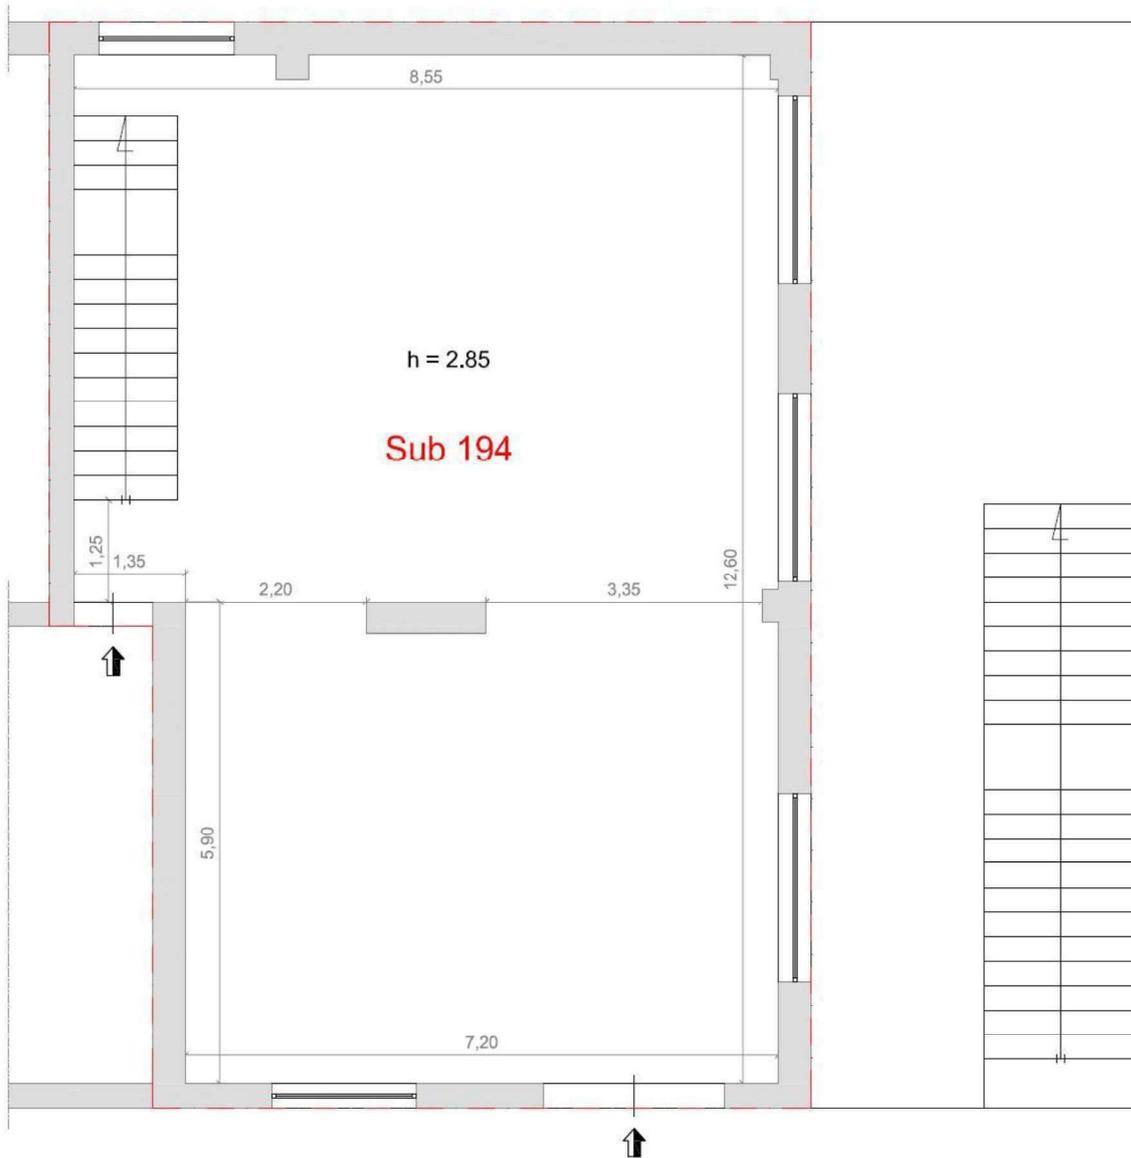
Planimetria Catastale Attuale, Piano Terra, Foglio 48, p.lla 76, Sub 194 (Ex Sub 1).
